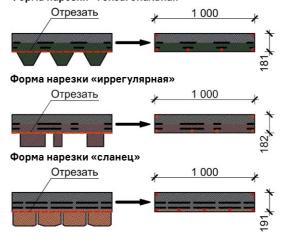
Схема изготовления карнизной черепицы из рядовой и расположение гвоздей.
